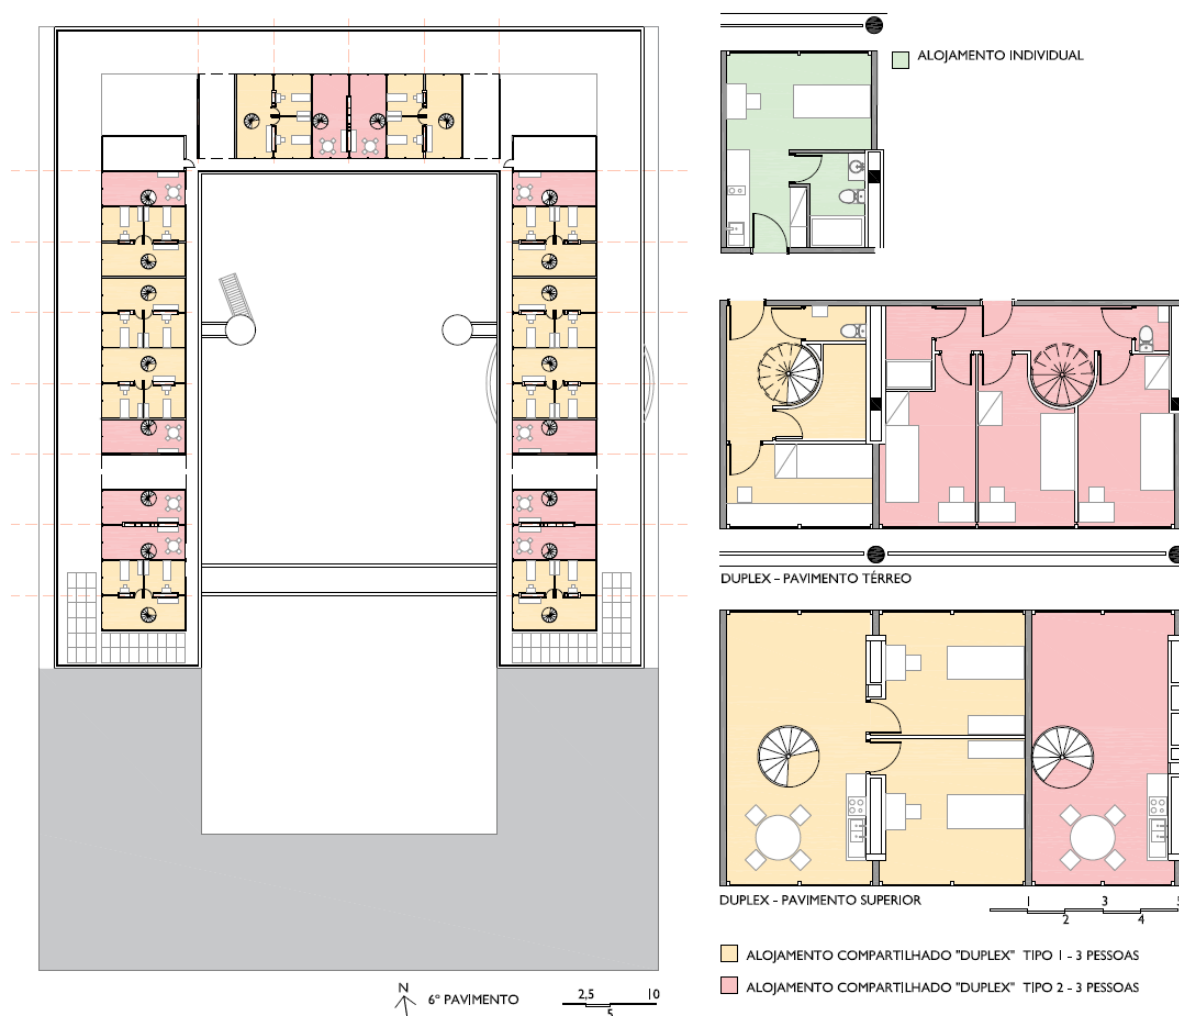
Planta do 6º pavimento e tipologias habitacionais principais.
